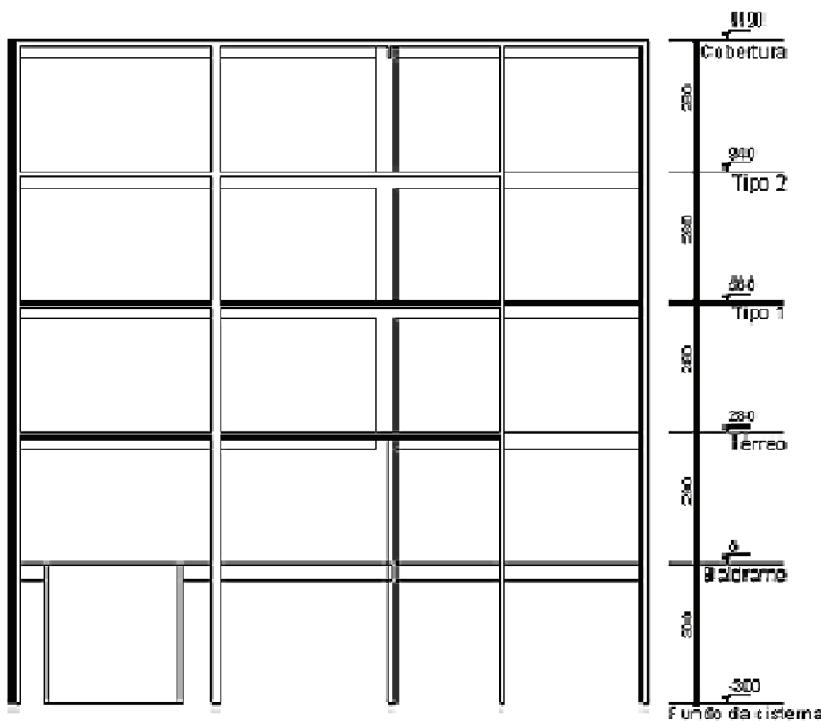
Cotas em corte vertical (estrutura vertical para lançamento de uma cisterna)
